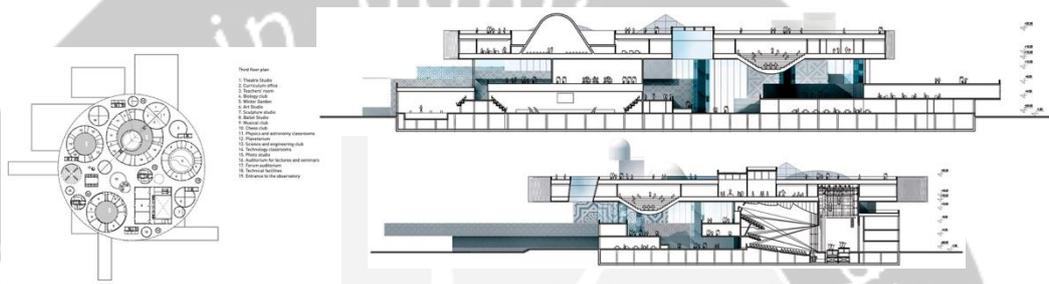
Blok Massa Palace of School Children/ Studio 44 Architect
